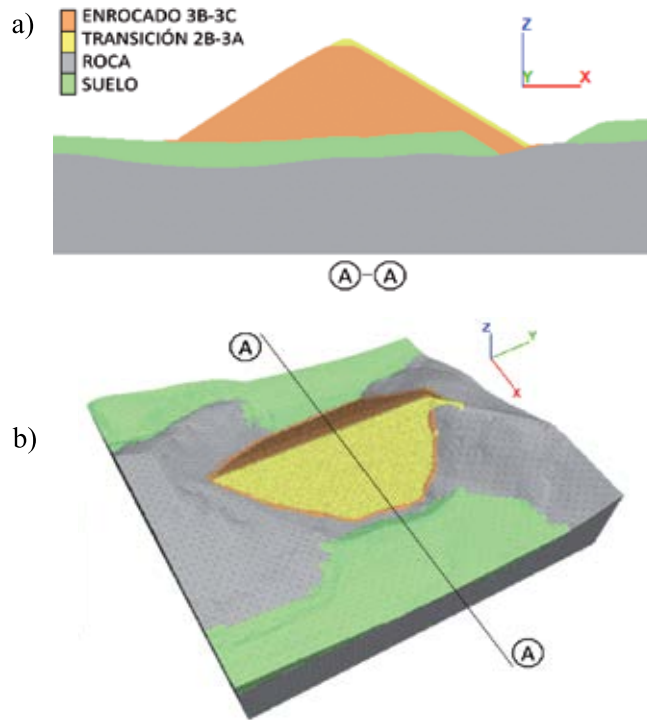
a) Sección transversal de la presa y b) modelo 3D en FLAC
